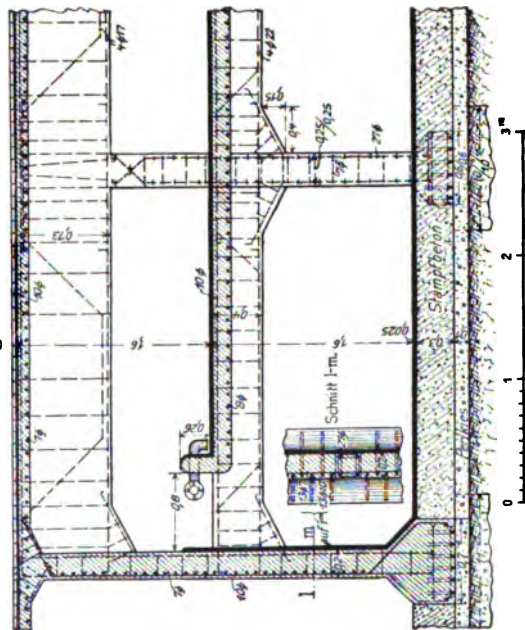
Thermalwasserbehälter in Wiesbaden.
